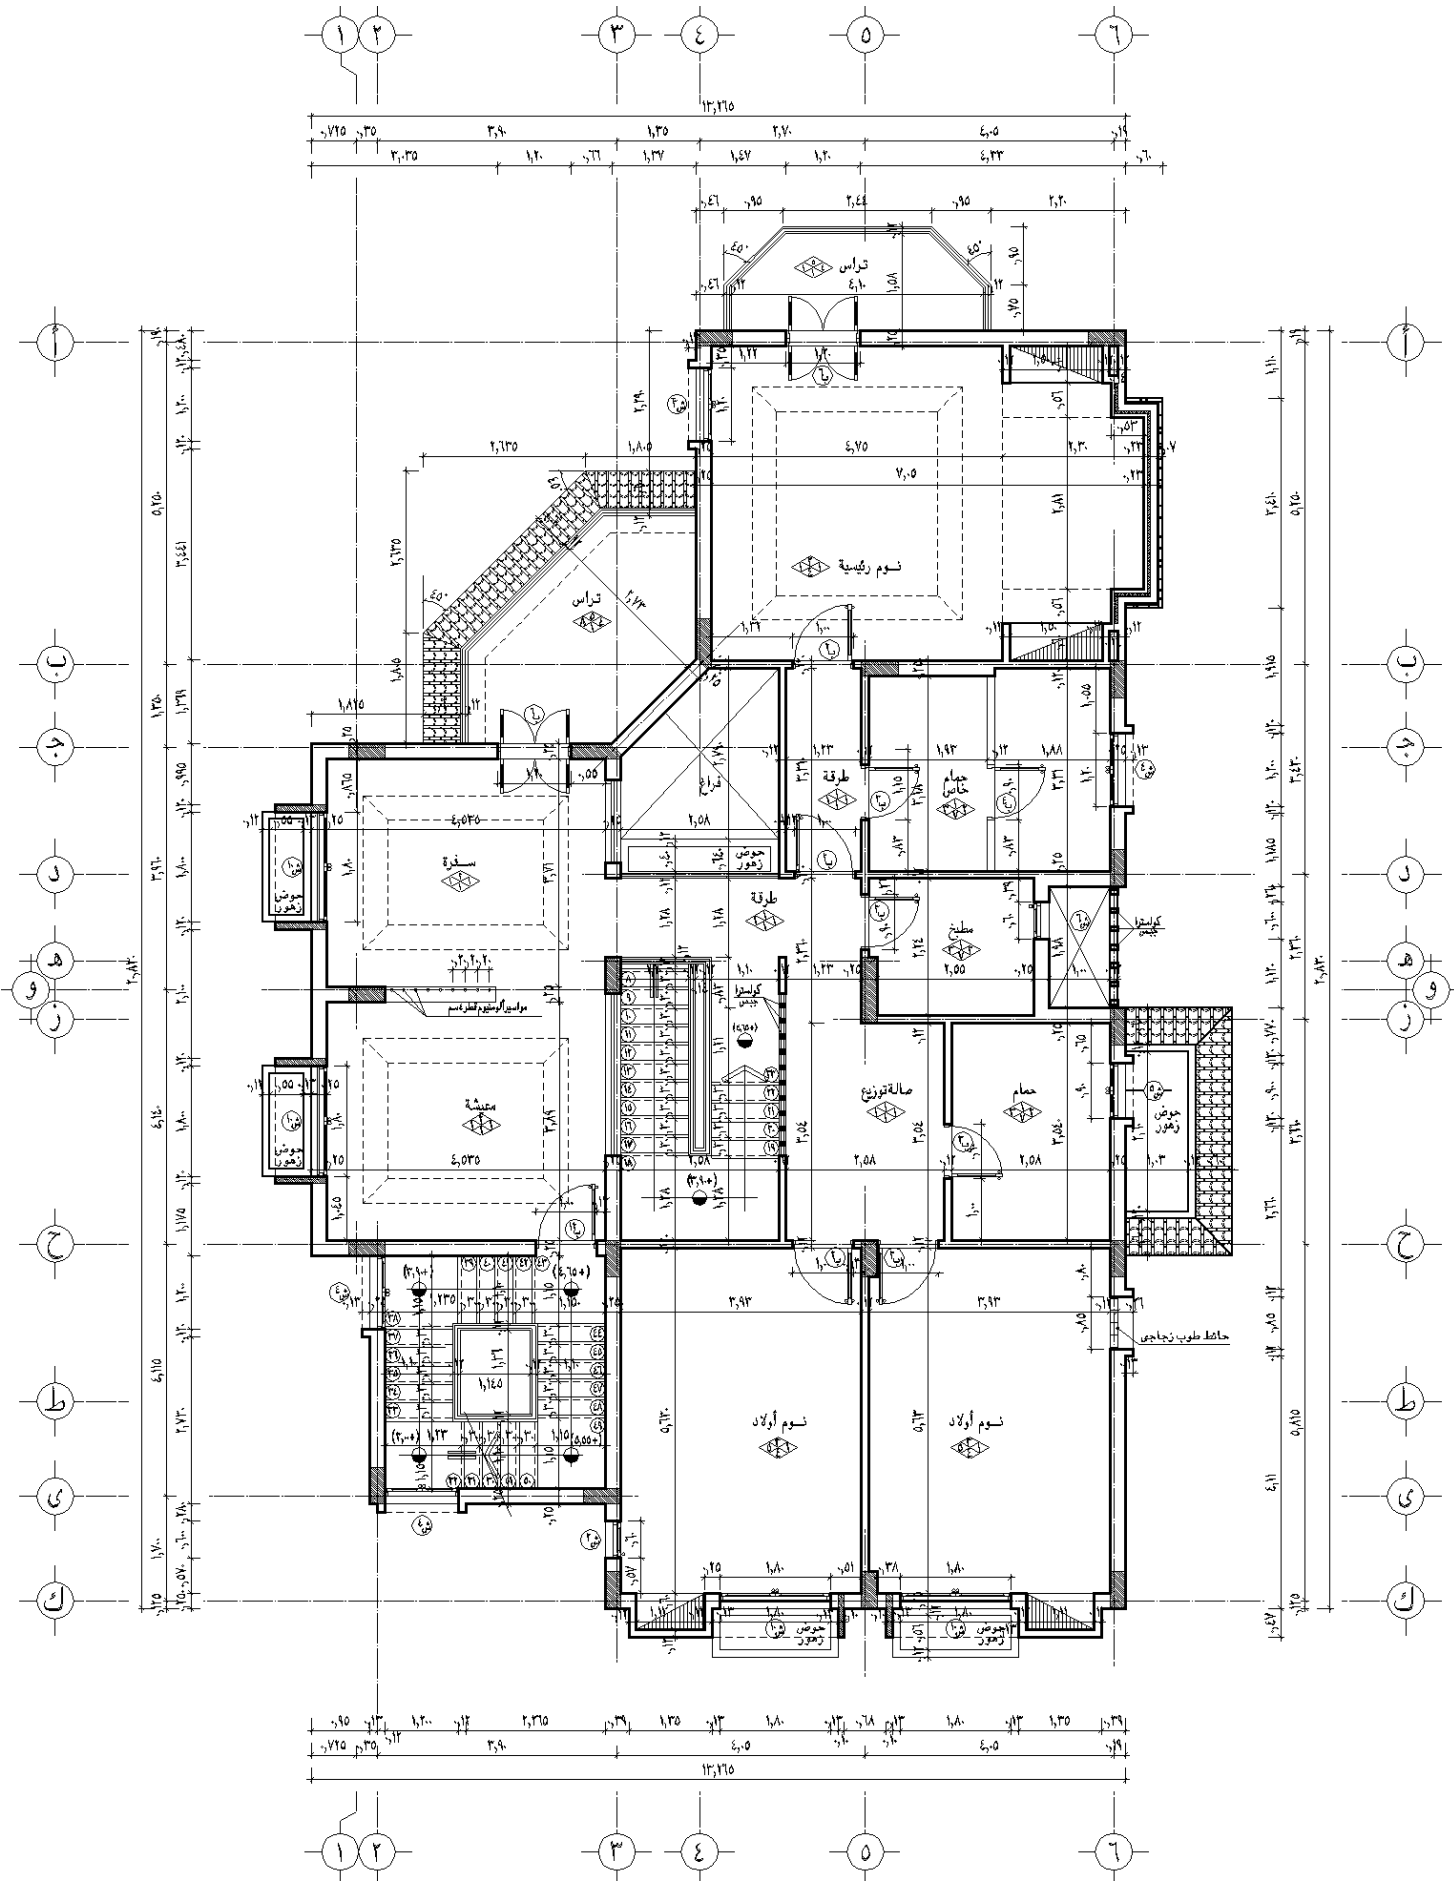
مثال على محتويات لوحة مسقط أفقى تنفيذى
